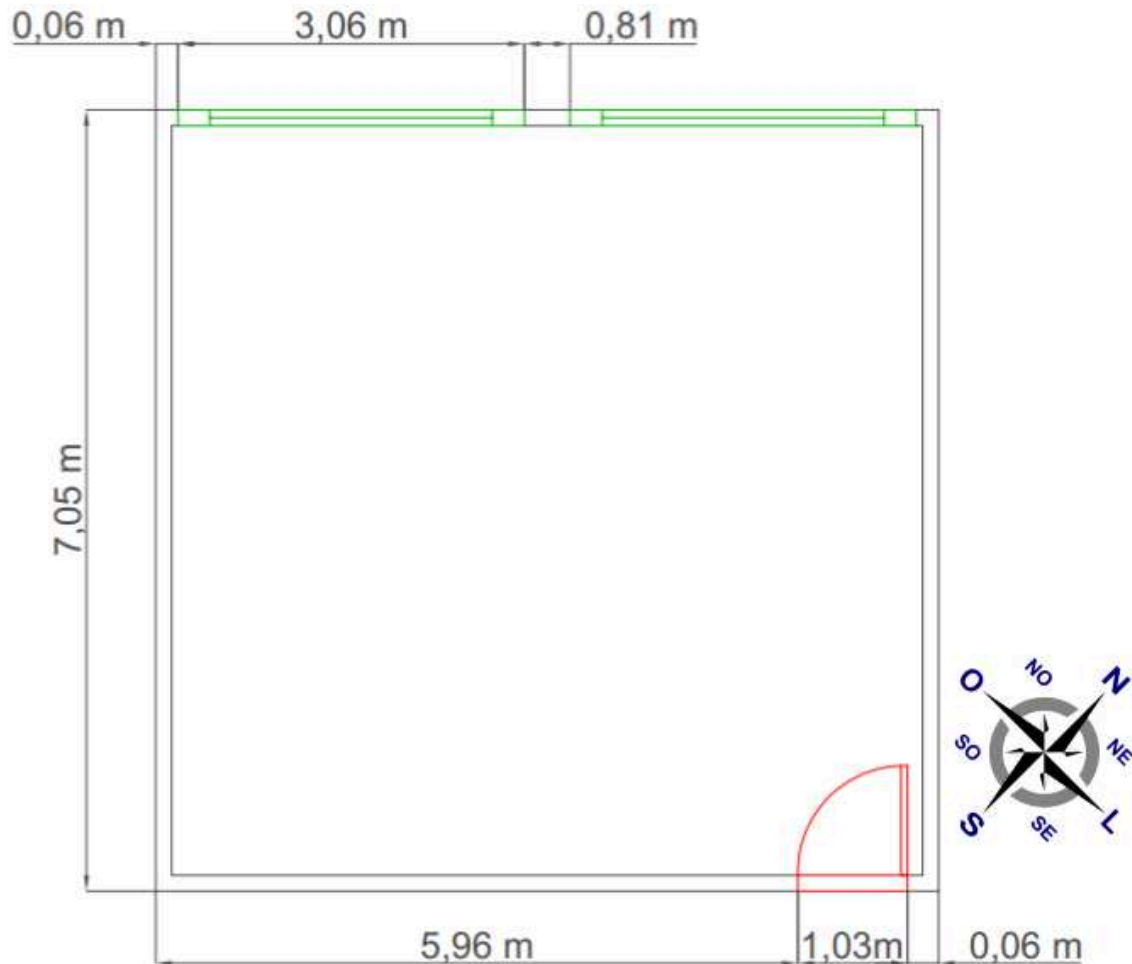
Planta baixa da sala em estudo. Fonte: do autor
